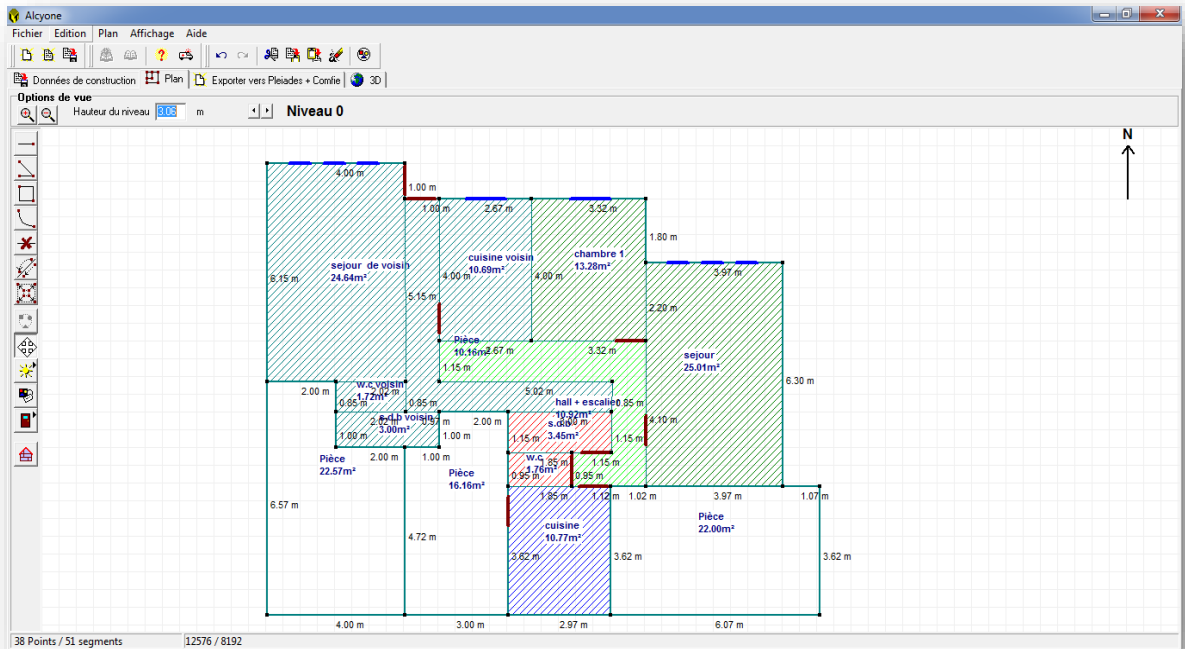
PLAN RDS DESSINE PAR ALCYONE
